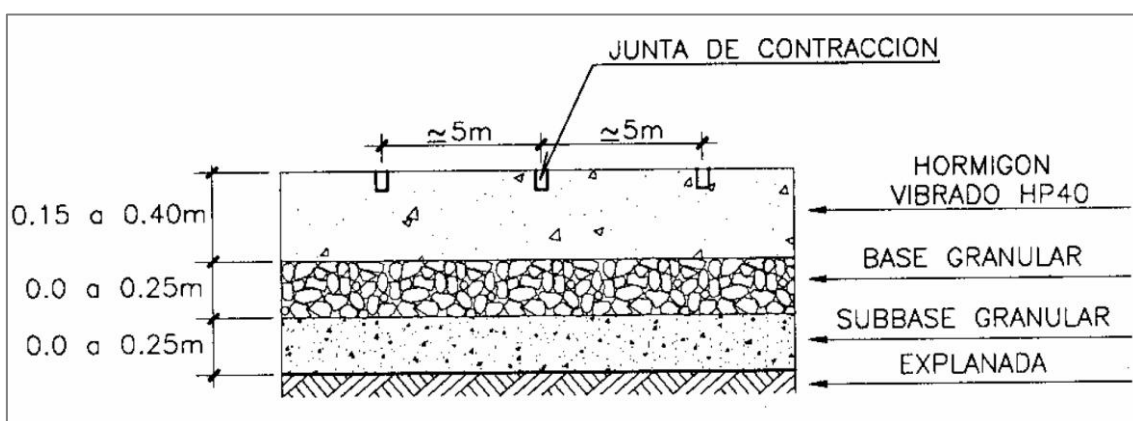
Sección de firme de hormigón vibrado (ROM 4.1-94)
